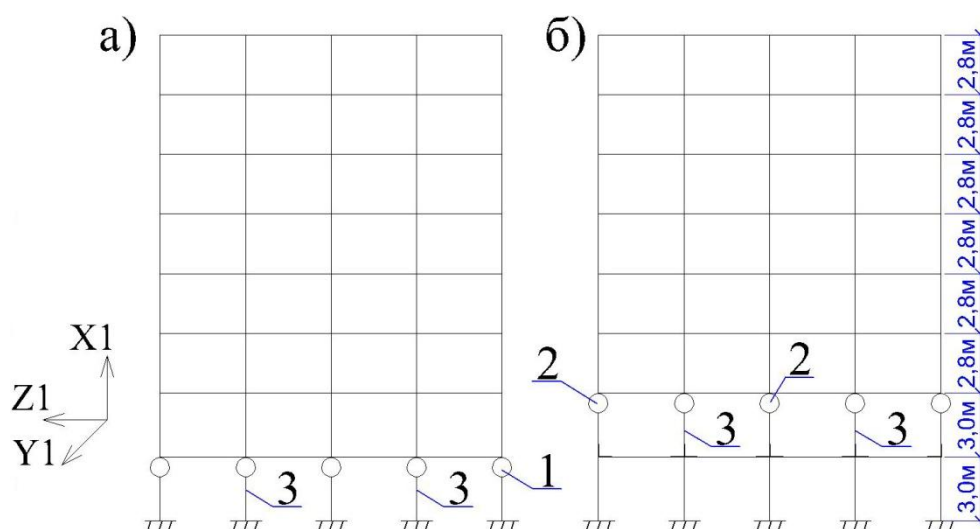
а) расчетная схема здания в продольном направлении; б) расчетная схема здания в поперечном направлении; 1- шарнир вокруг оси Z; 2- шарнир вокруг оси Y1; 3- эквивалентная колонна.
